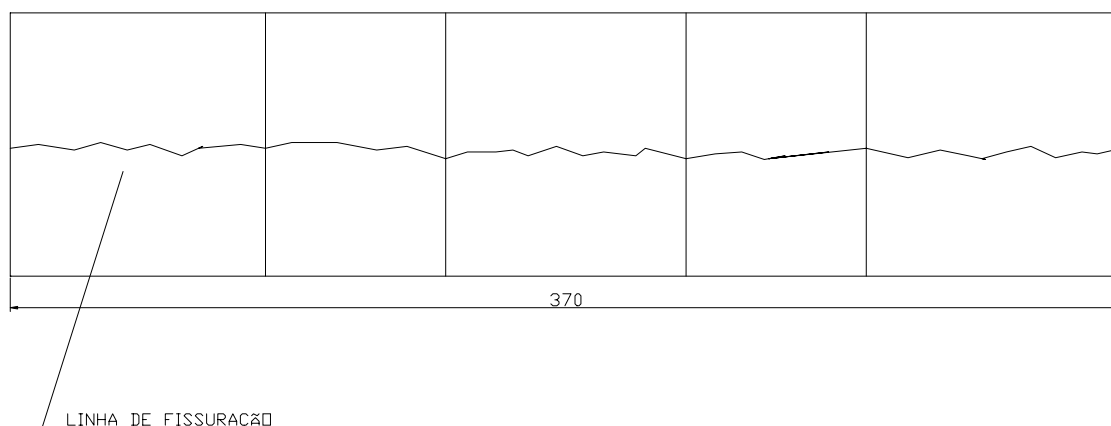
Fissura típica observada nos ensaios de viga mista.
